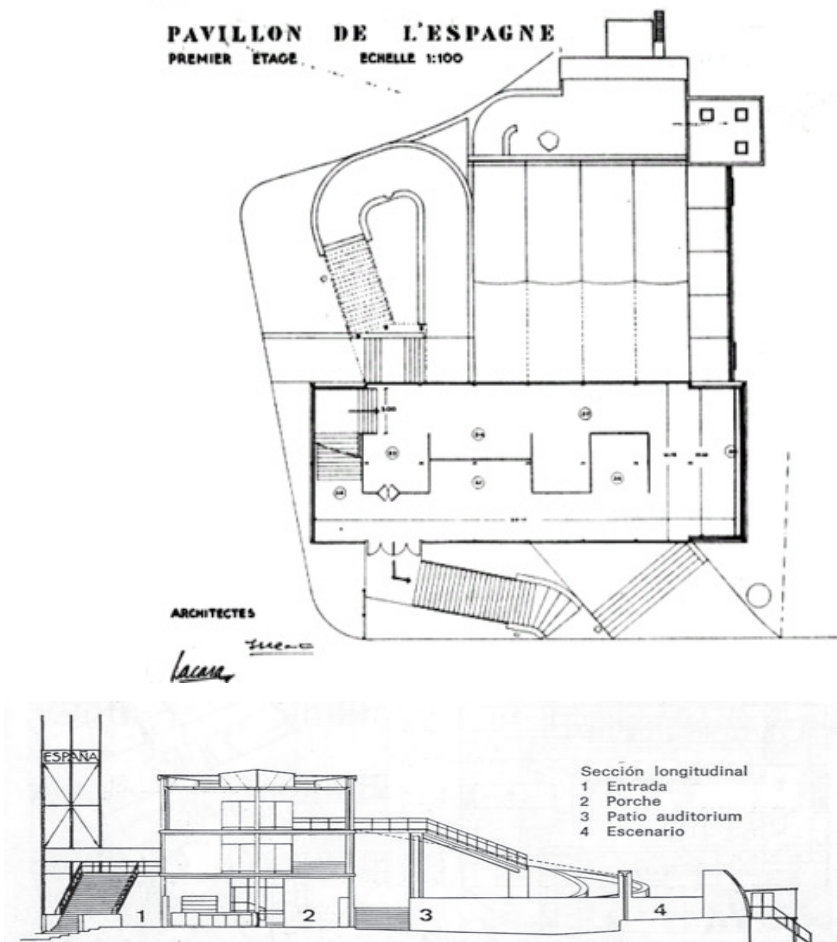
Primera planta (arriba) y sección longitudinal (derecha) del Pabellón de España, 1937. Fuente: Archivo de Arquitectura Urbipedia
